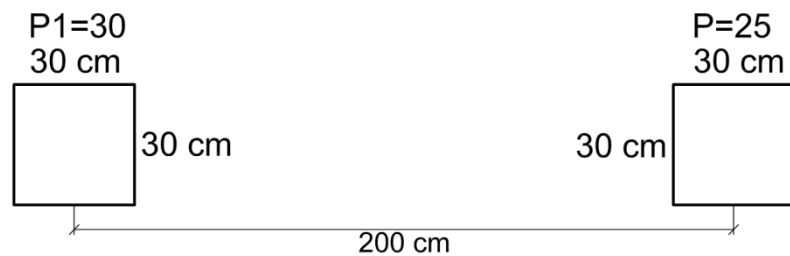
Planta dos pilares para o dimensionamento de sapatas associadas
